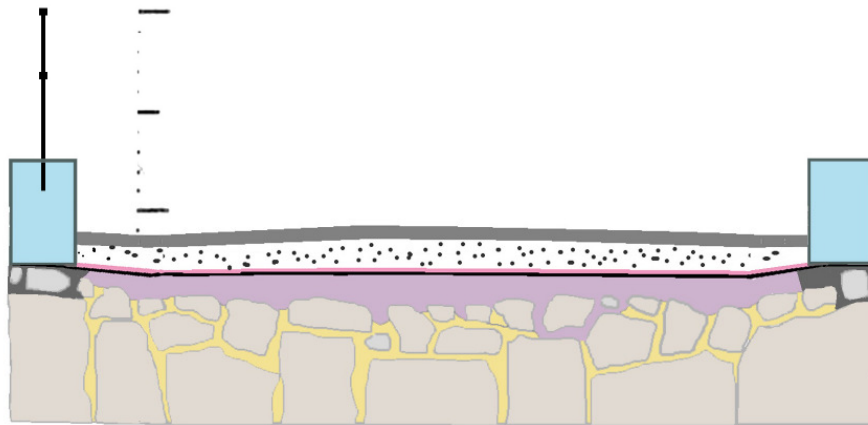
zeigt die aus den Sondierungen und Kernbohrungen erlangten Erkenntnisse zum inneren Aufbau der Brücke. Die Mauerdicke im Kämpferbereich beträgt über 1.7m. Die Füllung des Brückenkörpers besteht hauptsächlich aus kleineren und grösseren Bruchsteinen.
